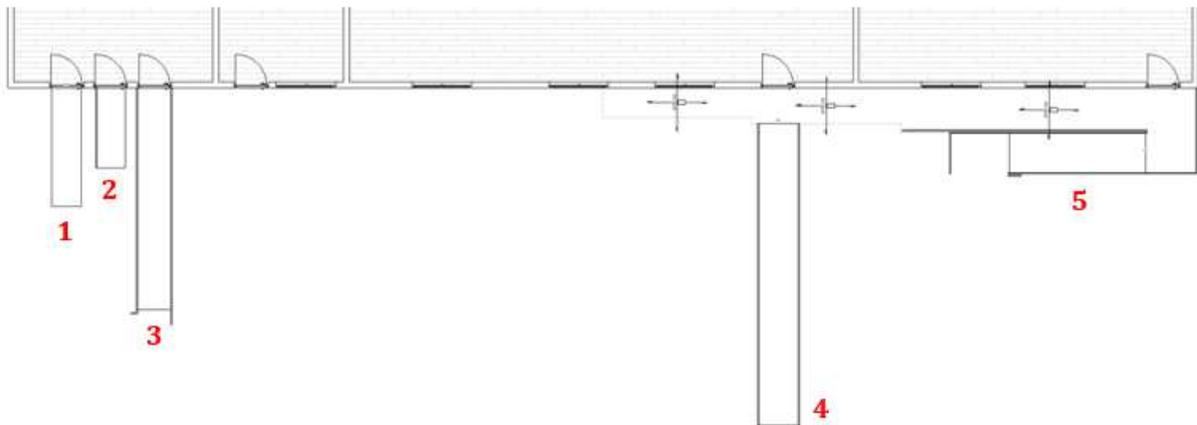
Grundriss der Rampen BIM-Modell OIB RL 4 – 2.2.2
